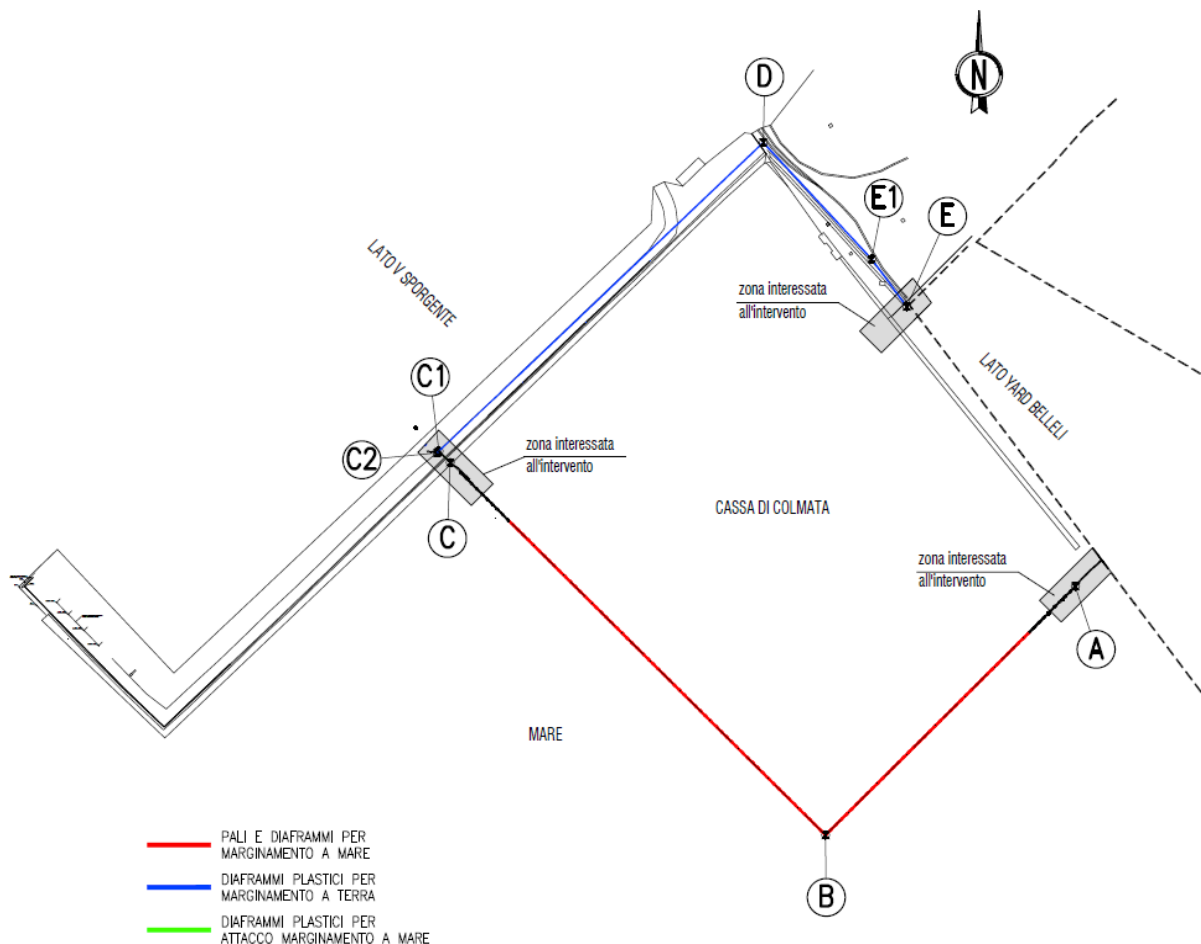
Pianta chiave cassa di colmata e vertici di chiusura marginamenti
